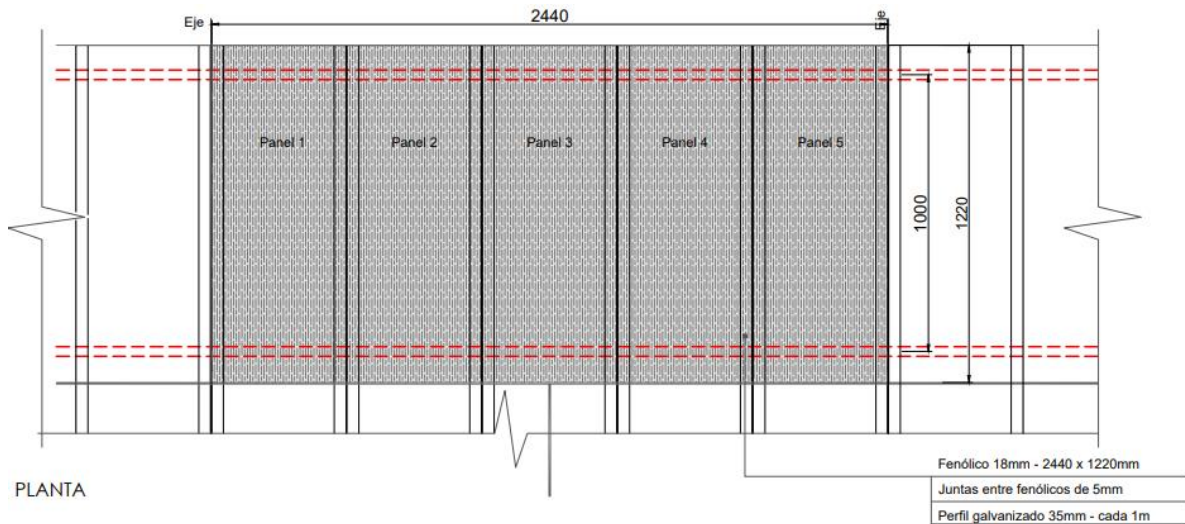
Detalle constructivo panales de entrepiso. Fuente: (<http://entrepisos.lnargentina.com/wp-content/uploads/2019/03/plano-3.pdf>)
